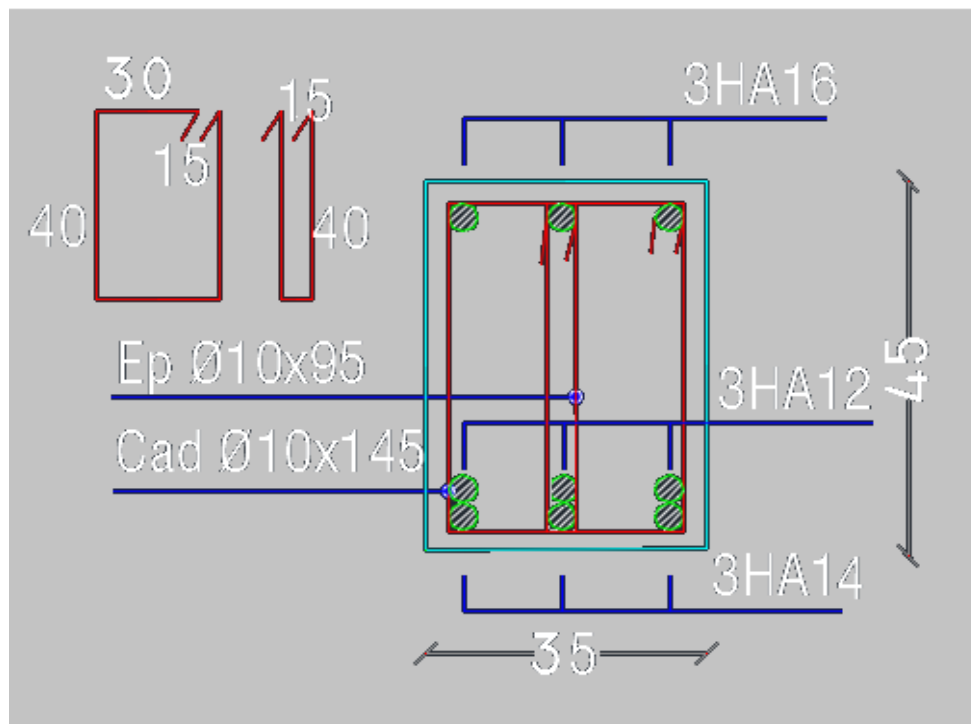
Ferrailage des poutres principales au niveau de travée de 14<sup>ème</sup> et 15<sup>ème</sup> étage.
